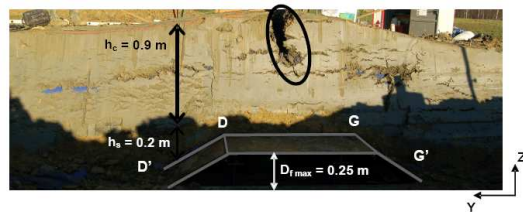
Coupe verticale de la planche T3 à la fin de l'essai d'après Camp (2008).
